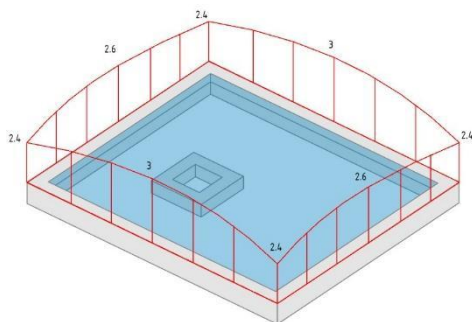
Схема нагрузок после усиления монолитной плитой
